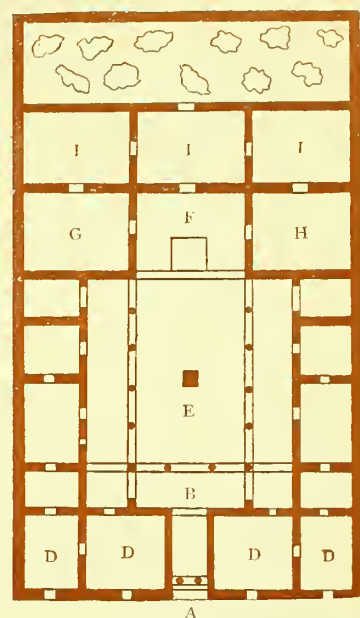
PLANTA DE UNA CASA HELÉNICA CON UN PERISTILO
